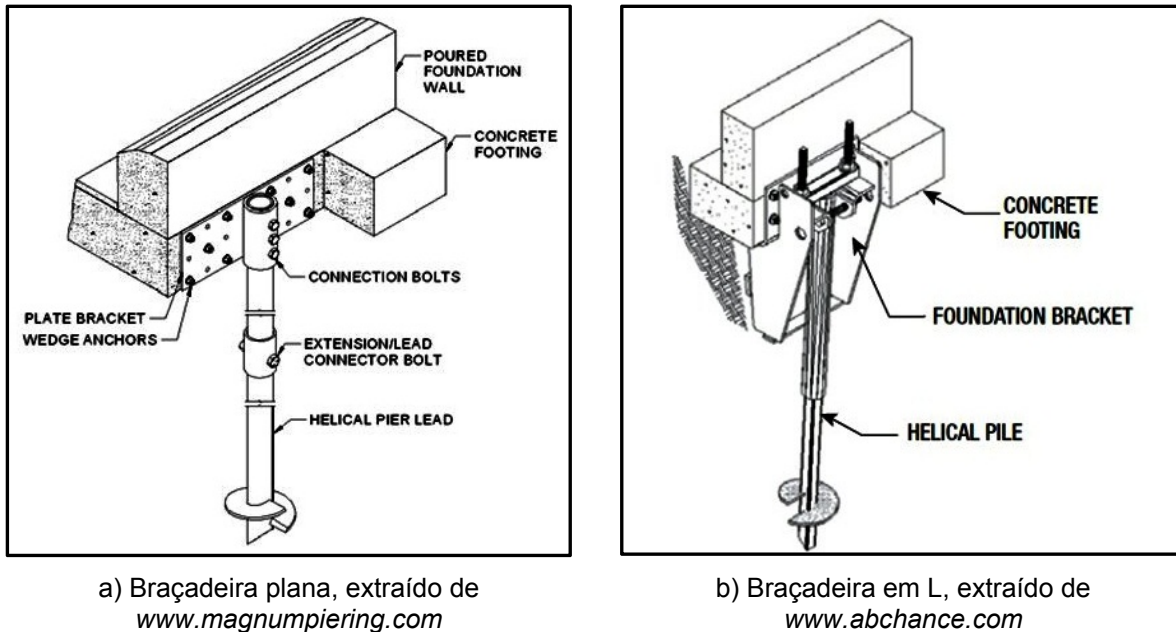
Ligações tipo com braçadeiras em recalçamento de fundações
